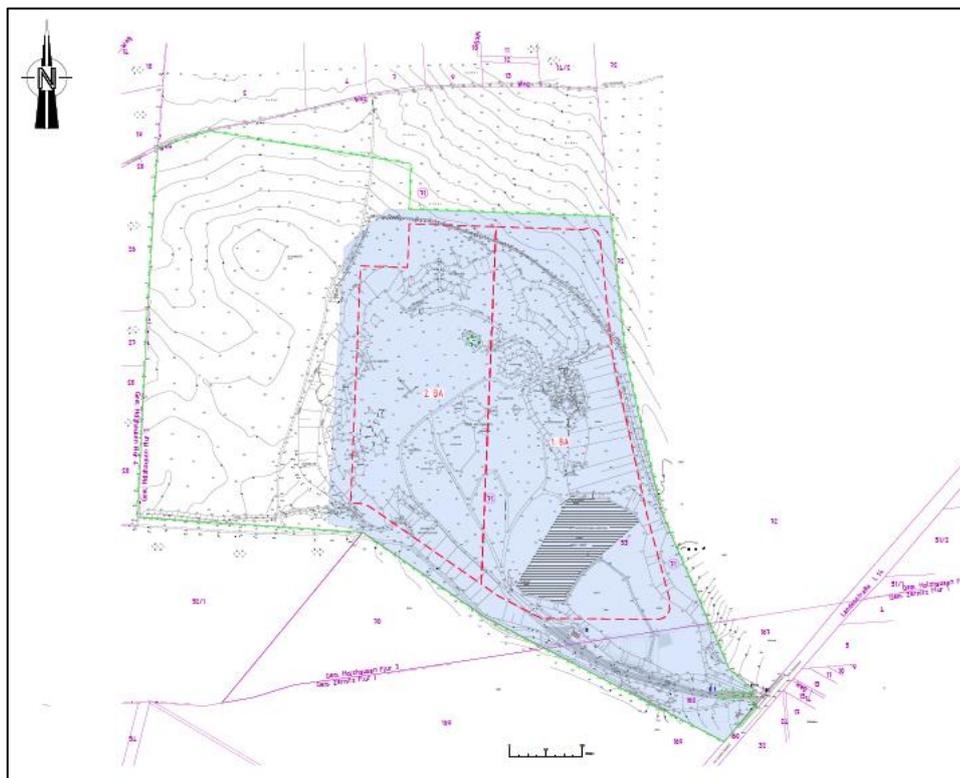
Bestandslageplan Tagebau mit geplantem Deponiebereich (blau) und den Bauabschnitten; Auszug aus Anlage 1 in /12/, Originalmaßstab 1:2.000
